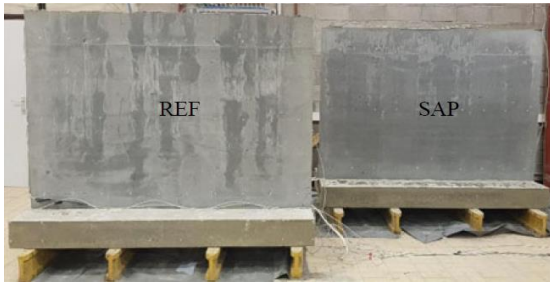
Fisuras en el muro de referencia sin PSA. El muro con PSA no sufrió fisuramiento. [166]
